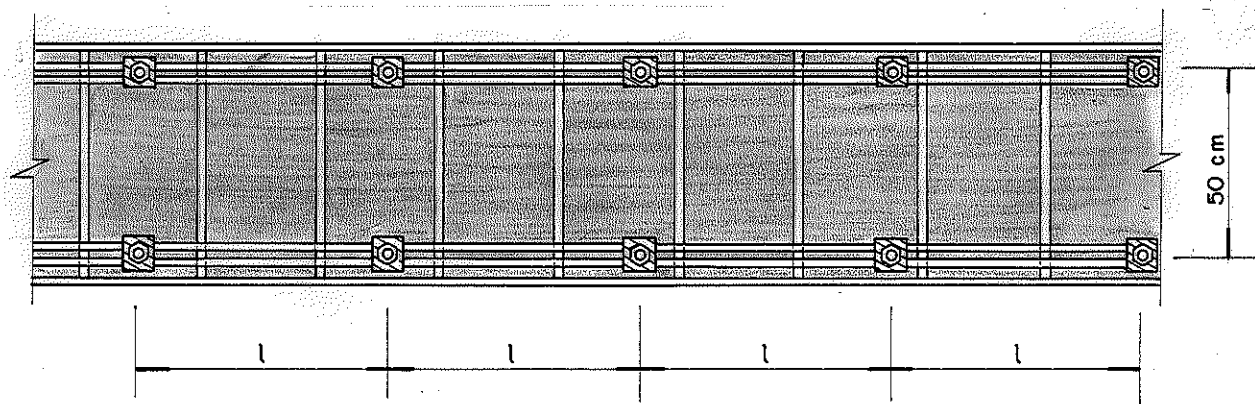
ESQUEMA DE FIXAÇÃO DO MÓDULO VERTICAL DA VIGA
